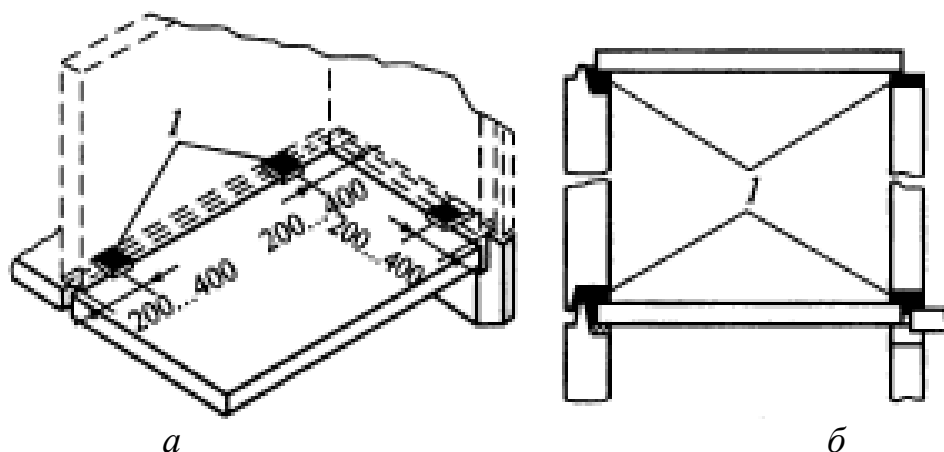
Выравнивание монтажного горизонта; *а* – установка маяков под панели; *б* – выравнивание стен и перекрытий; *I* – маяки
